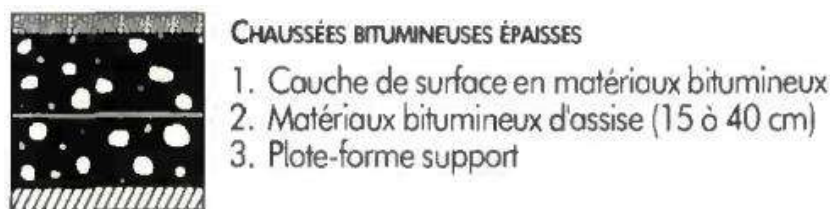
Structure de chaussée bitumineuse épaisse
